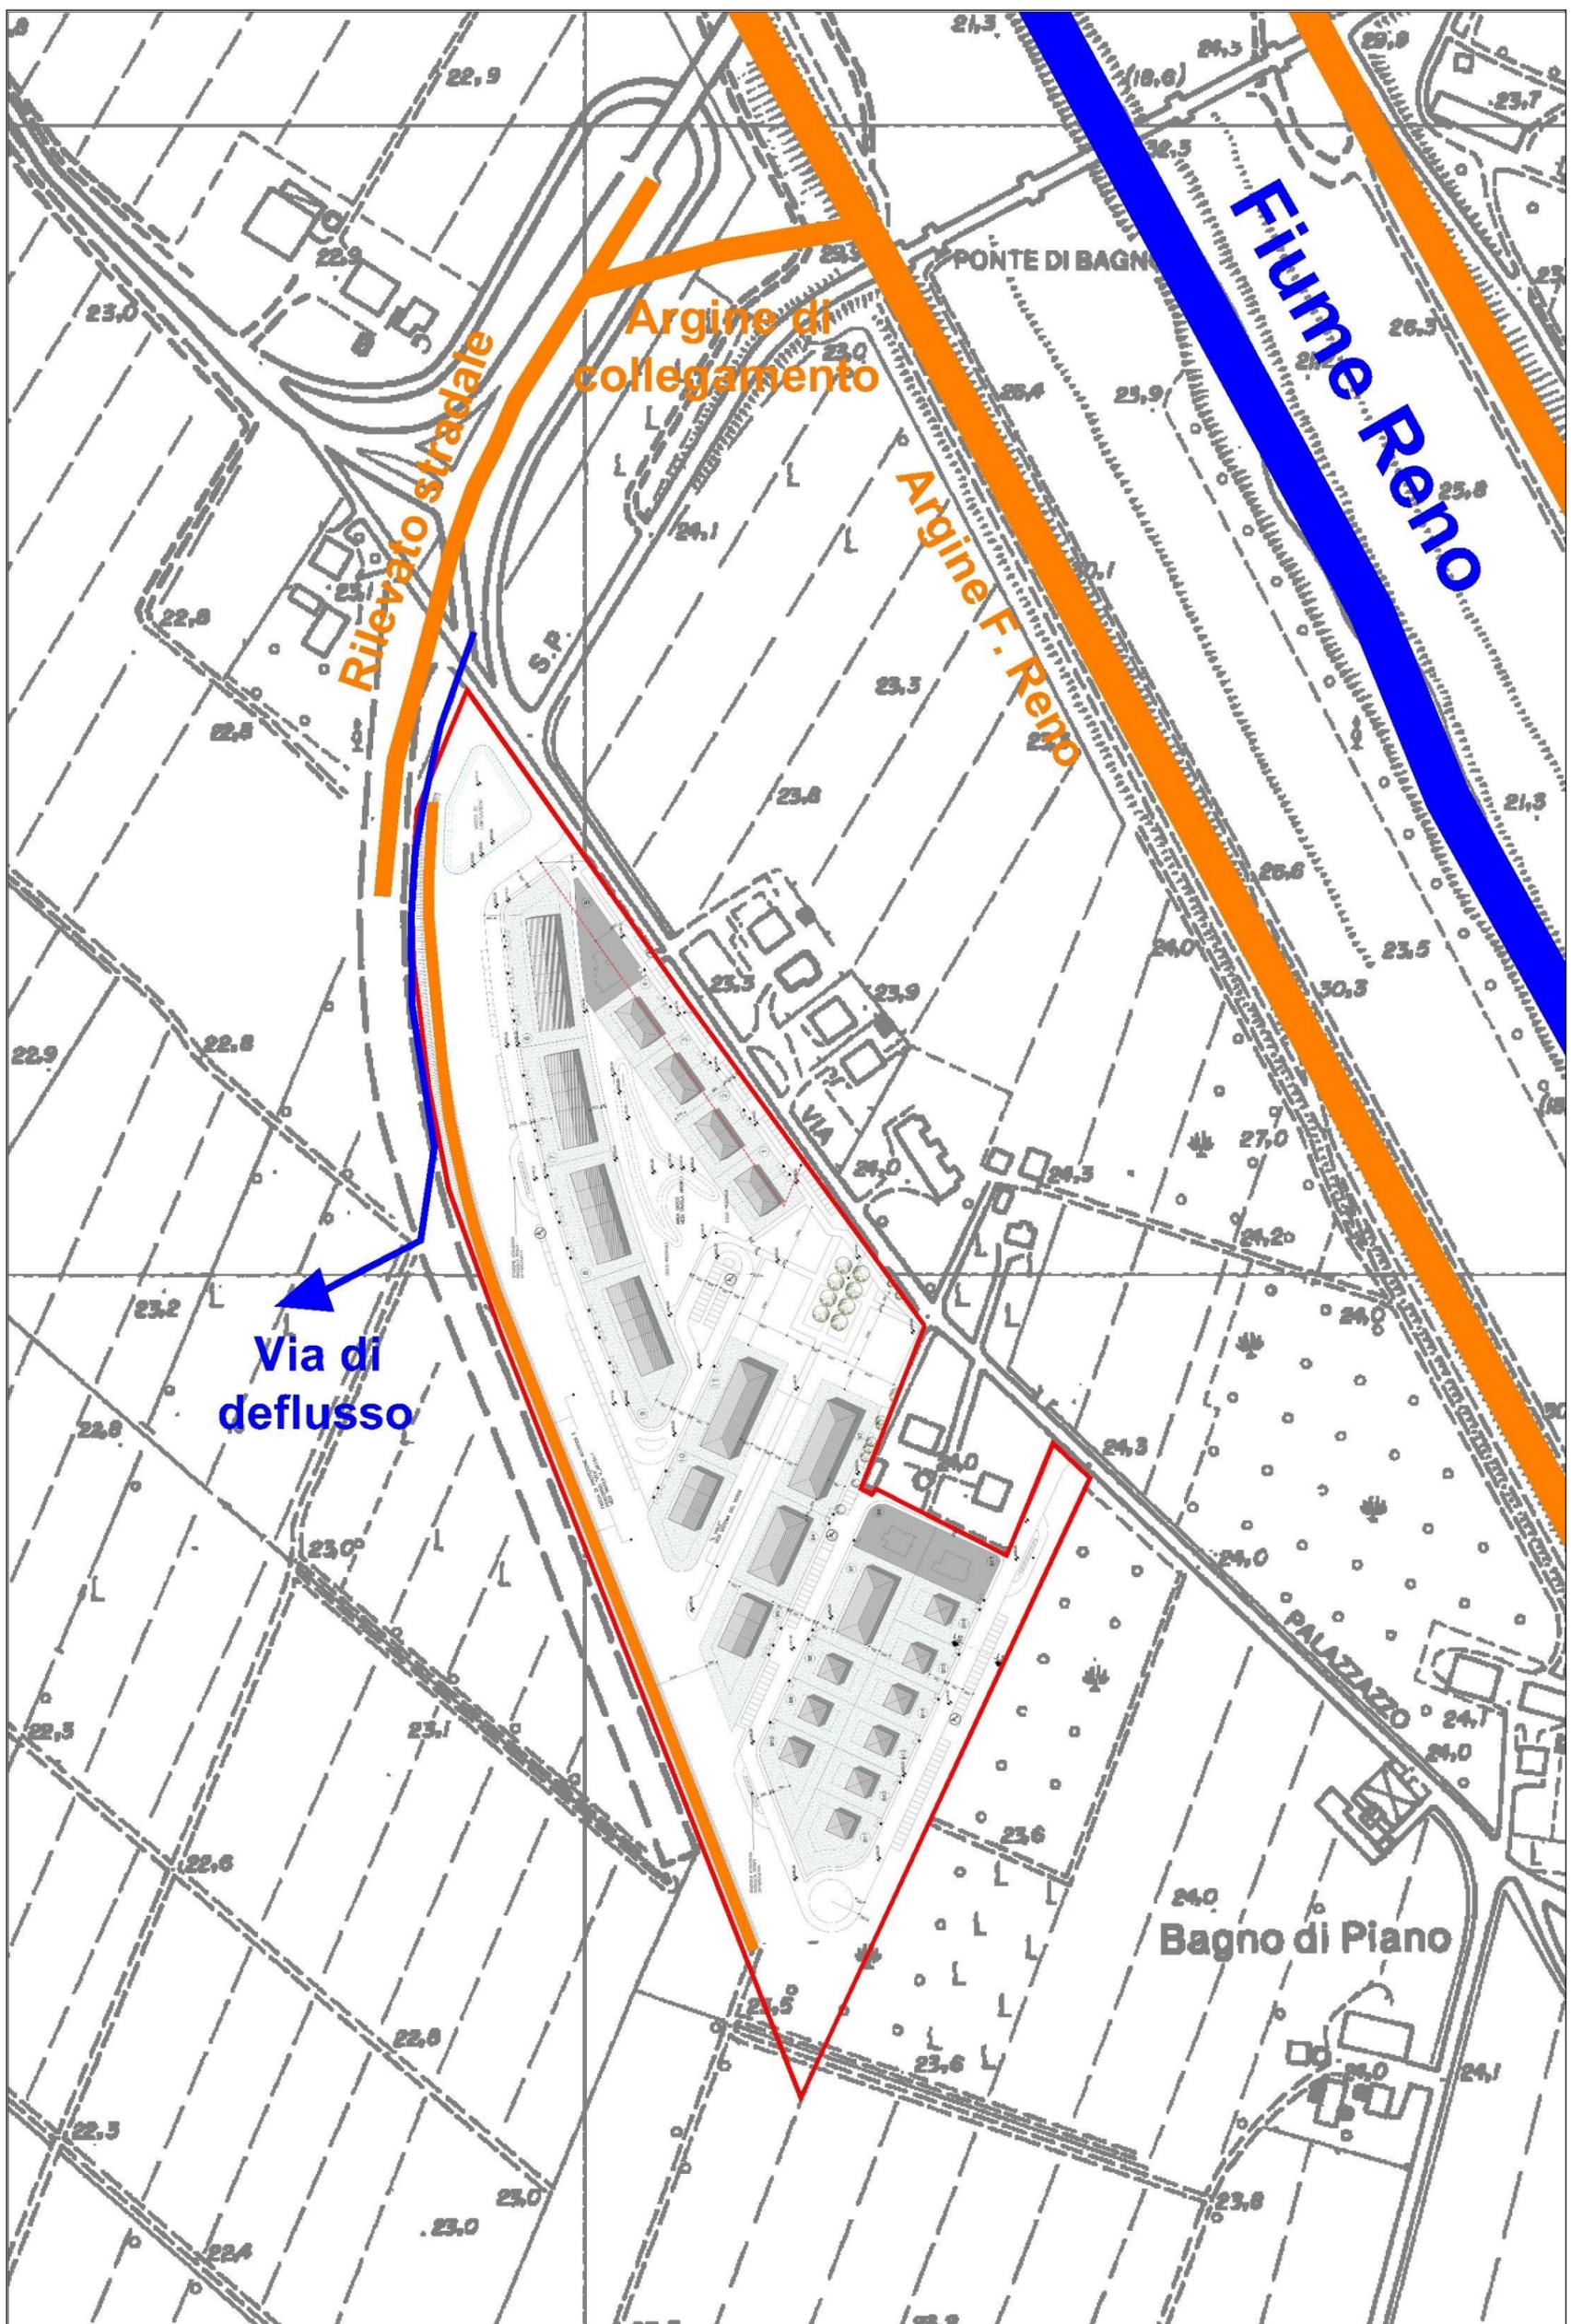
Planimetria di dettaglio degli elementi di valutazione del rischio idraulico (su base C.T.R.)
